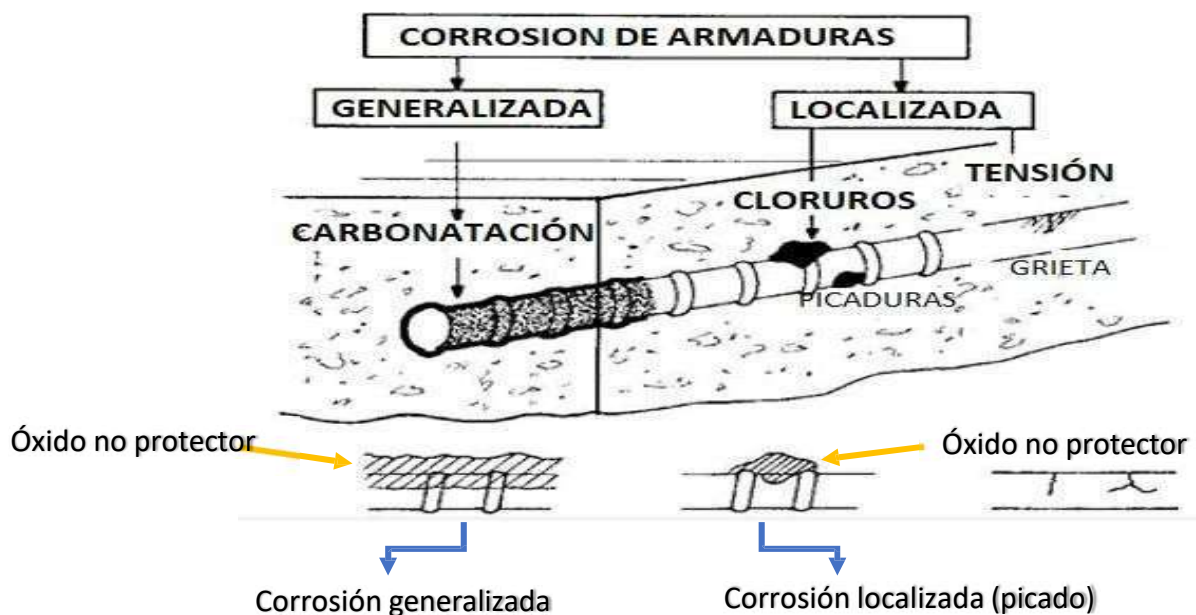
Principales mecanismos de corrosión de armaduras embebidas en hormigón.
